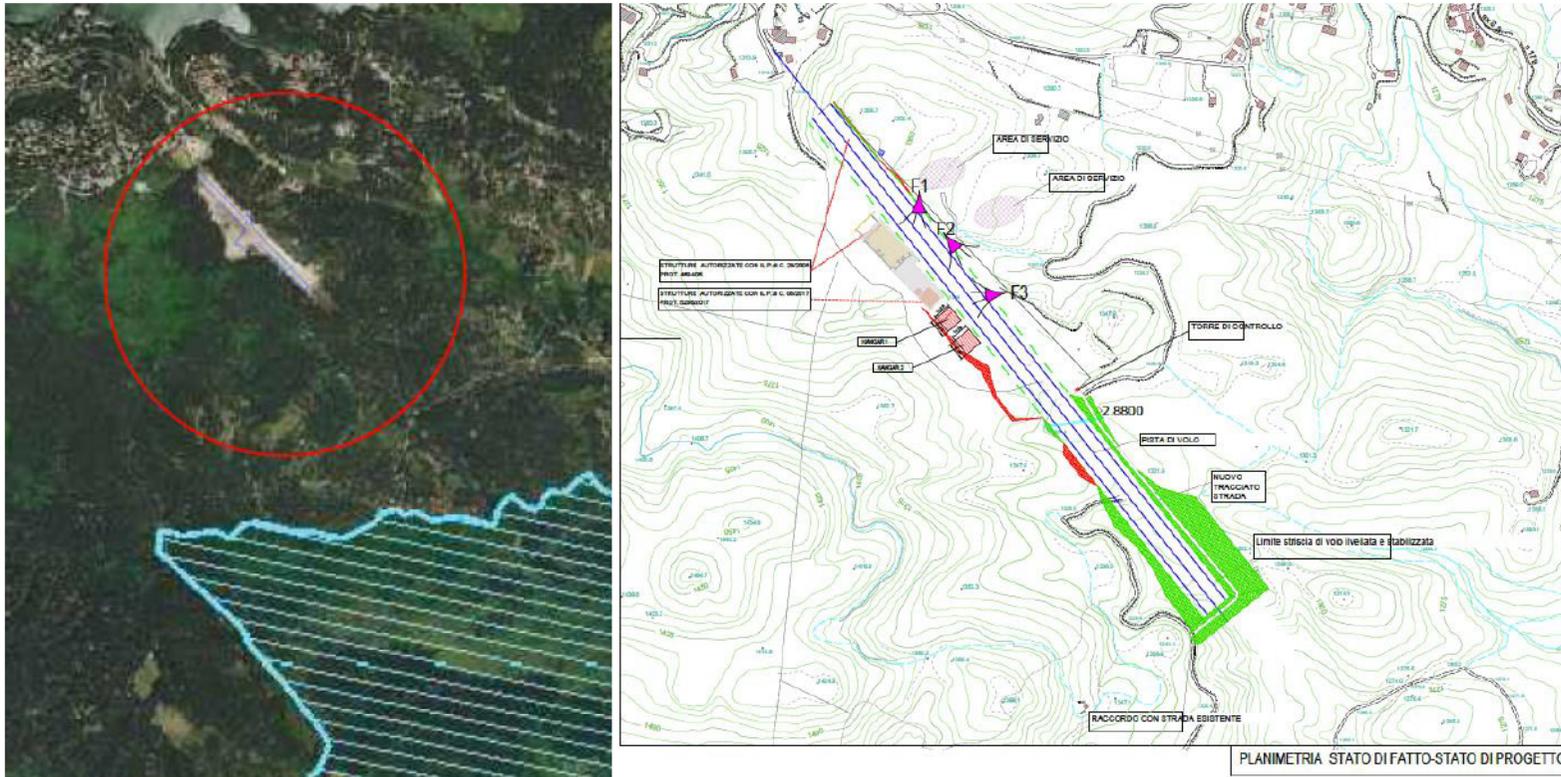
Planimetria dell'area con indicazione dell'opera in progetto
